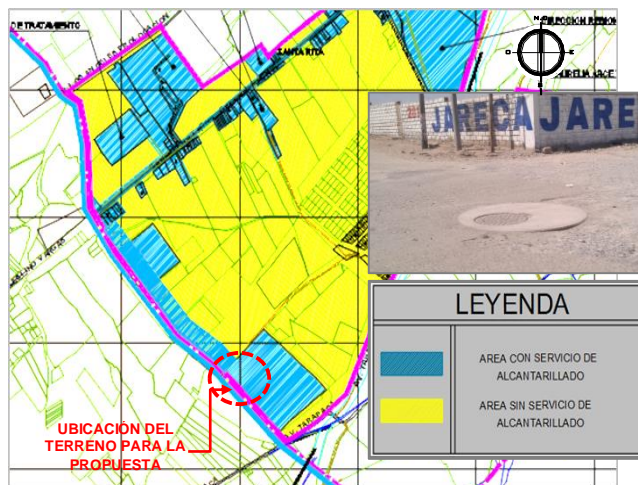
Plano del Sistema de Alcantarillado Distrito de Calana
